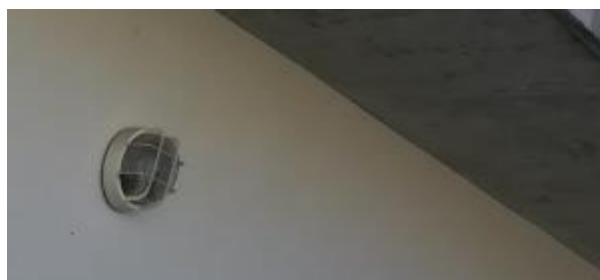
Detalle Iluminación Exterior Downlight Halógena de Pared.
